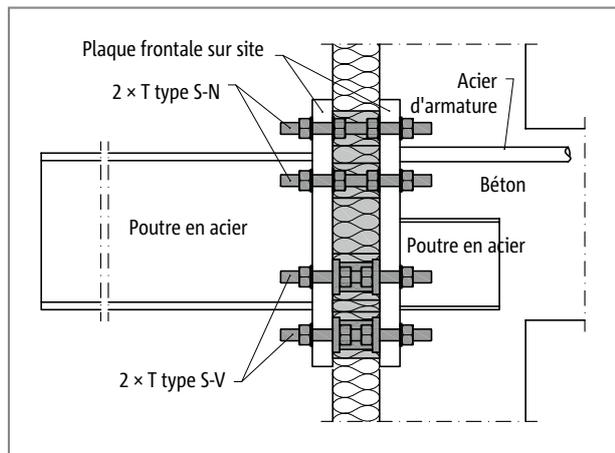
Schöck Isokorb® T type S-N et T type S-V : raccordement de structure en acier sur béton
